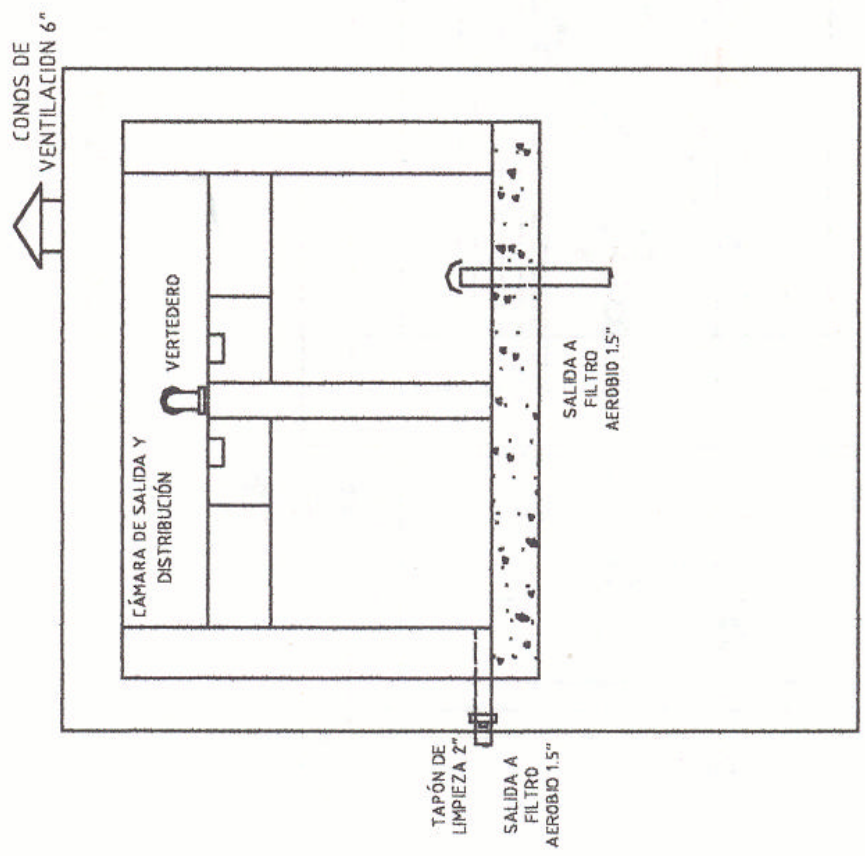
Vista en Planta Fosa Séptica Mejorada
